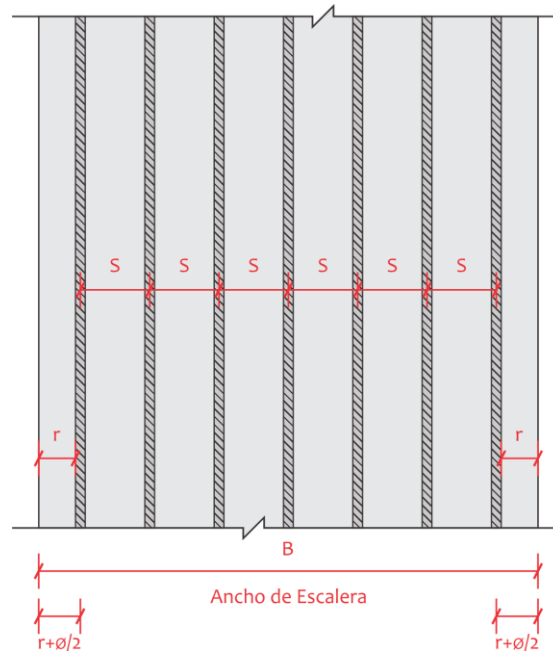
Espaciado a lo Largo del Ancho de la Escalera.
